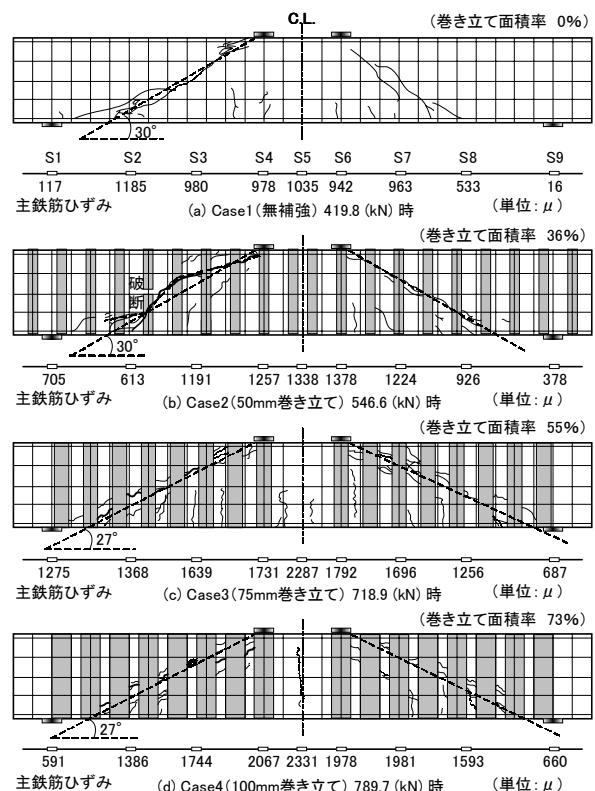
ひび割れと破壊性状 (最大荷重時)
